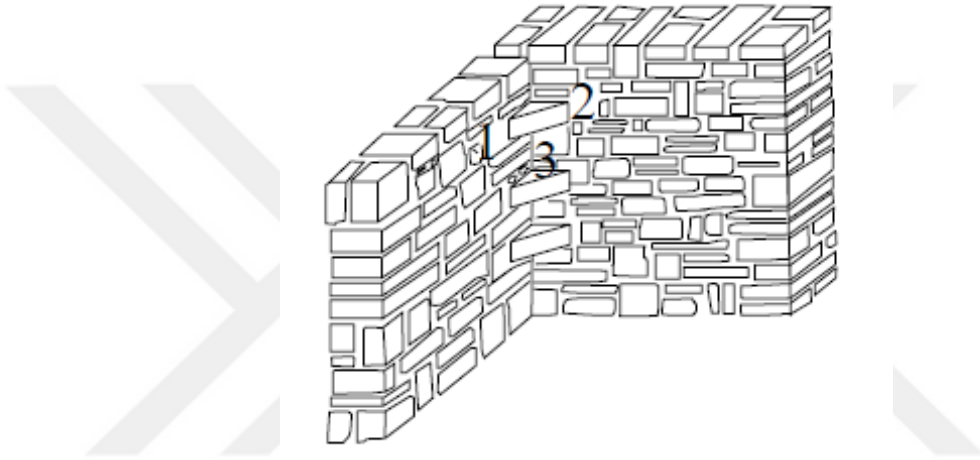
Duvardaki hasarlı kısmın beton ya da grout ile doldurulması
